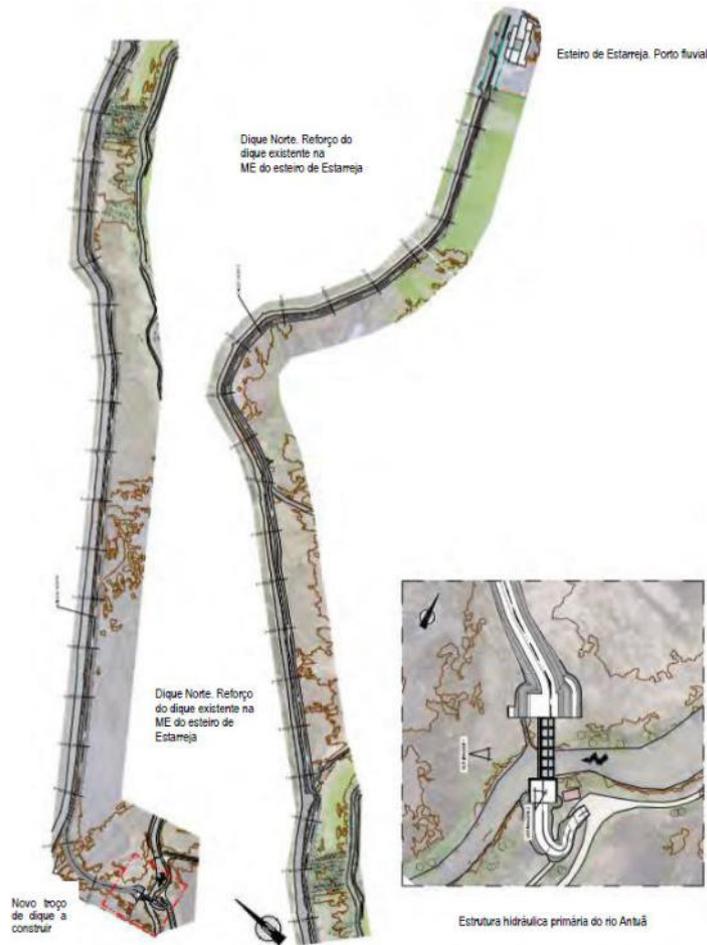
Planta geral do dique Norte e pormenor da estrutura hidráulica primária do rio Antuã (EHP5)
